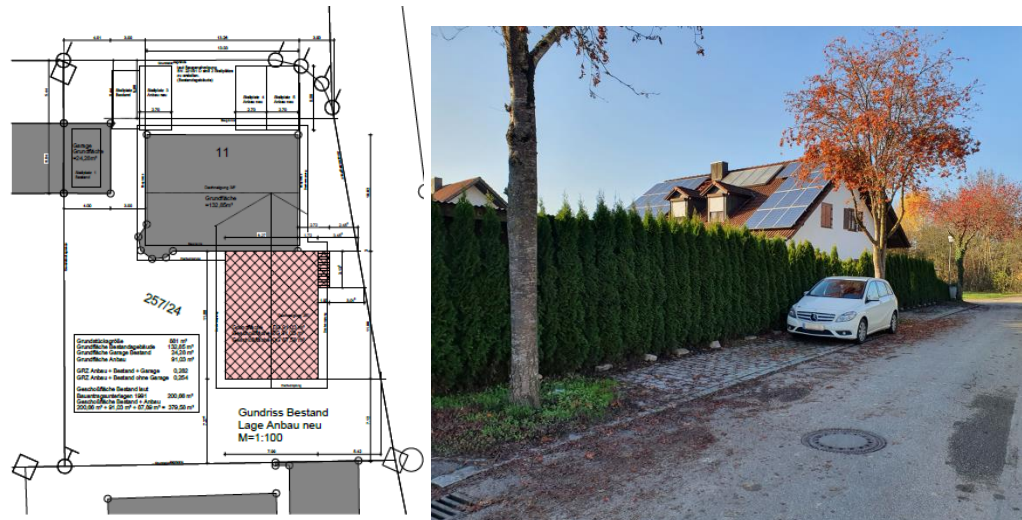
Bebauungsvorschlag Fehlbachstr. 11, Quelle: Planungsbüro Stefan Schimmer, PV
